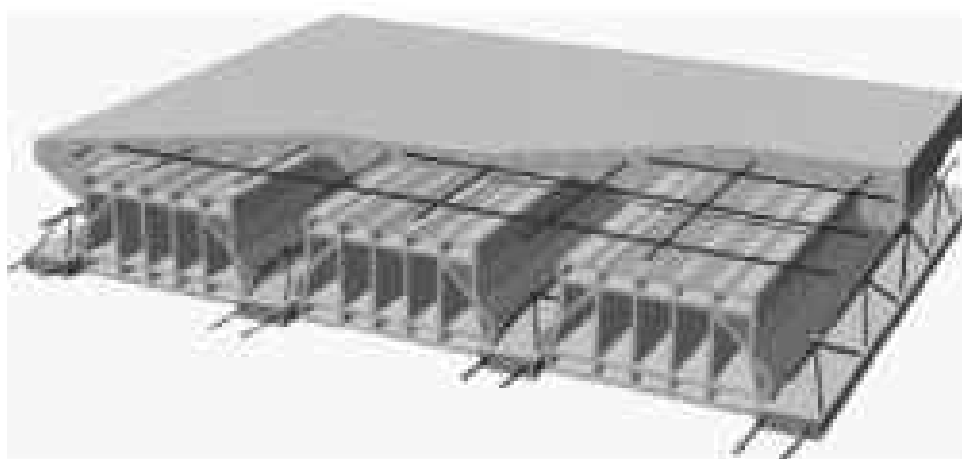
Esempio di solaio in cemento armato a travetti tralicciati e blocchi interposti
